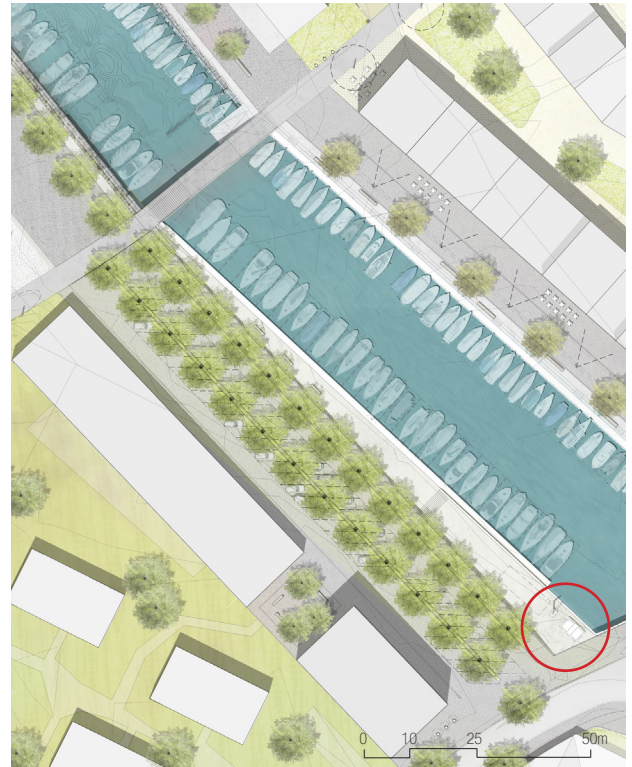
VARIANTE Standort Hafenkran - Dr. Schneiderstrasse
